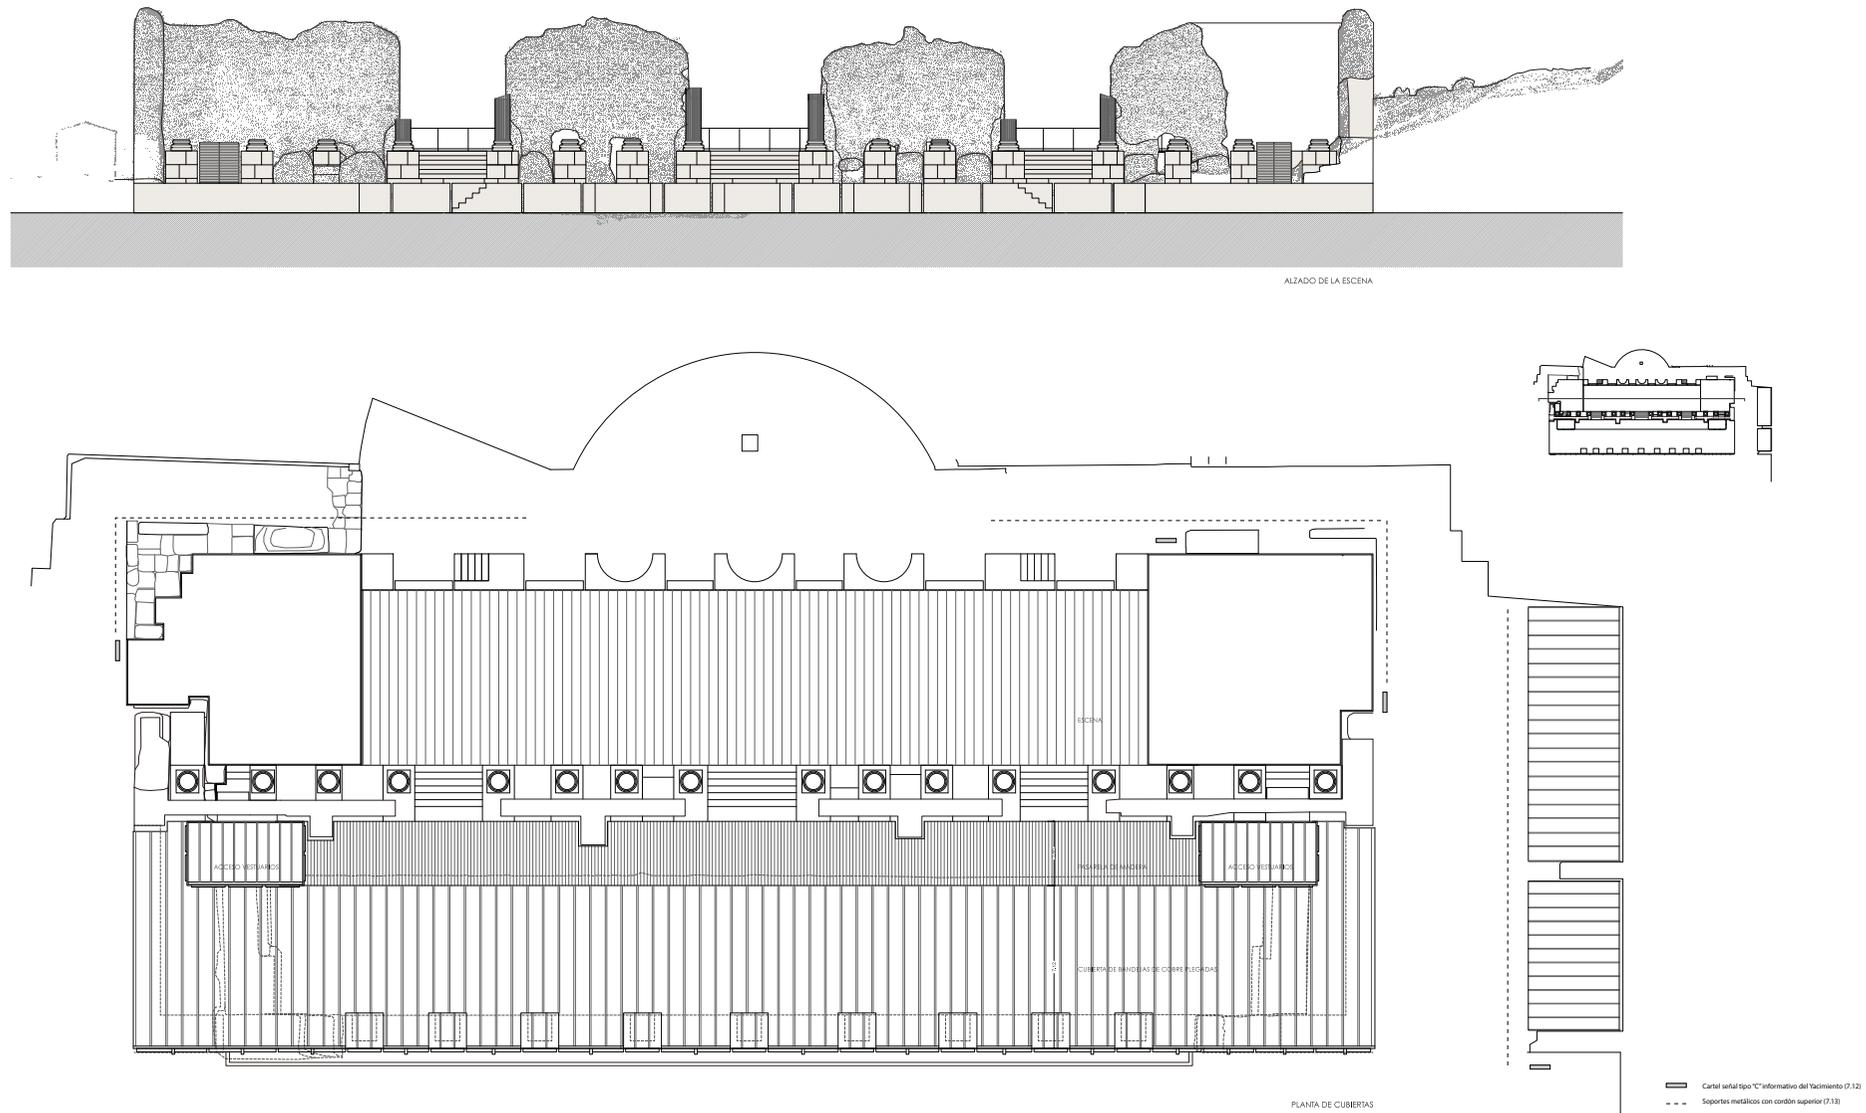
Alzado y planta de cubiertas de la scena (2017).
